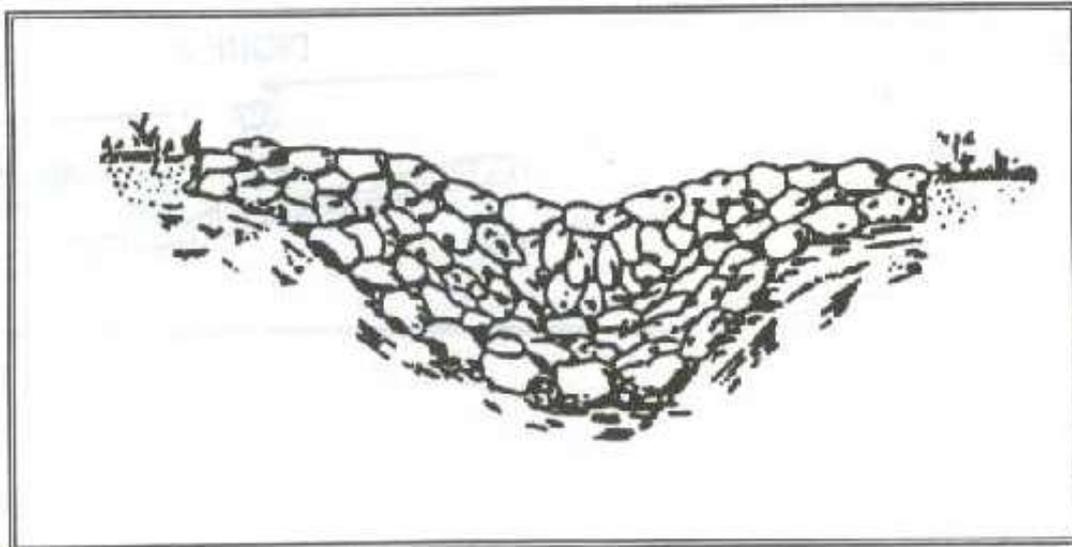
Corte BB' Vista de jusante para montante. FONTE: DNER, 1996
